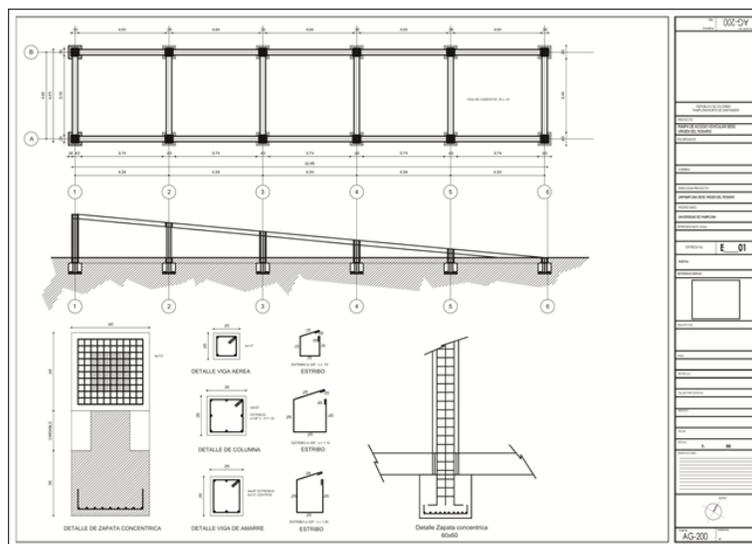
Plano de despiece de refuerzo zapatas y columnas para la rampa.
